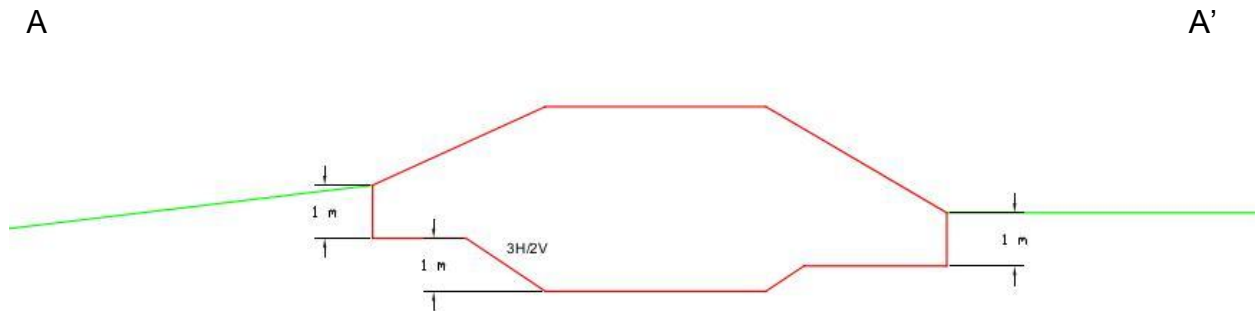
coupe de principe de l'ancrage de l'ouvrage
